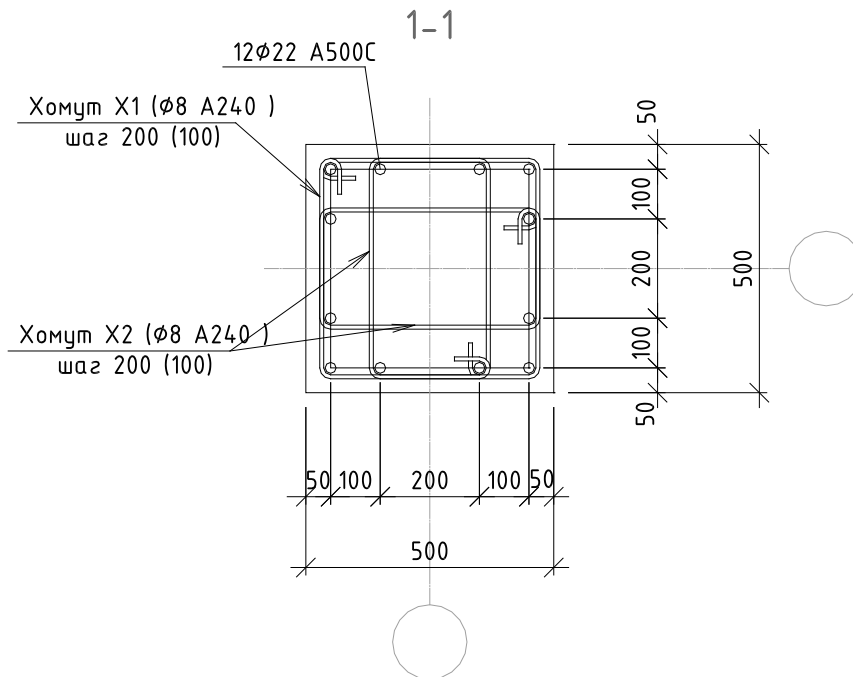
Принятая схема армирования (более подробное армирование показано на листе)
